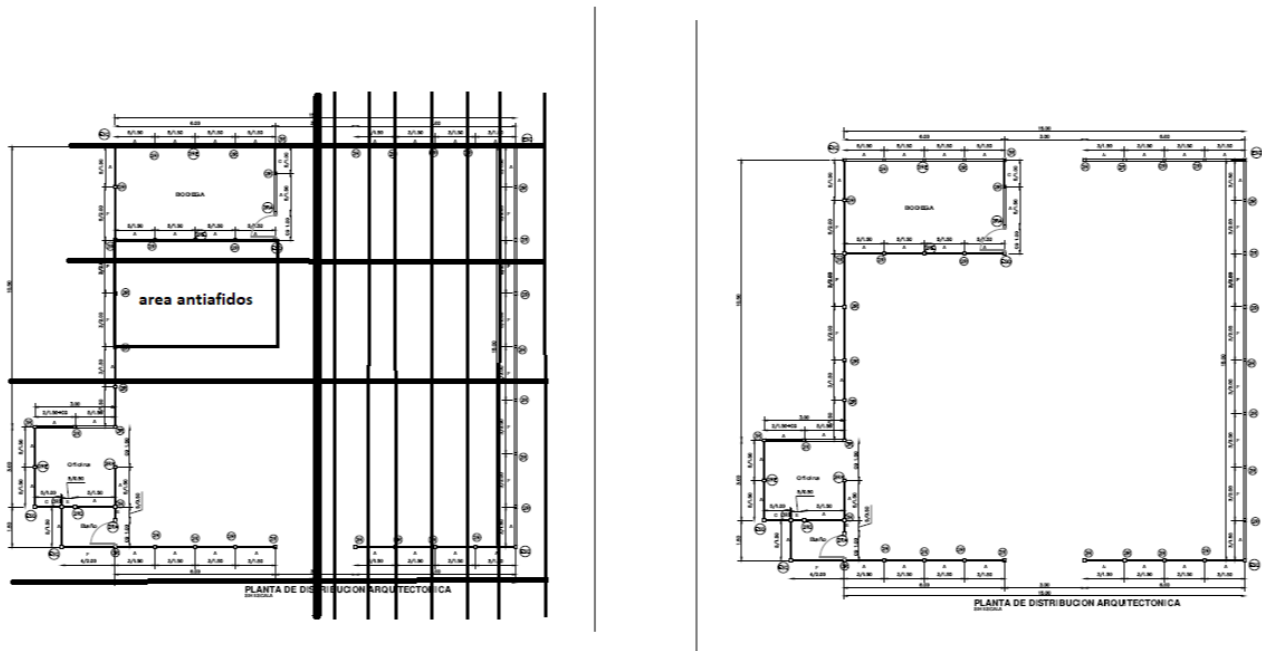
Croquis con detalle de distribución arquitectónica, incluye techo.
